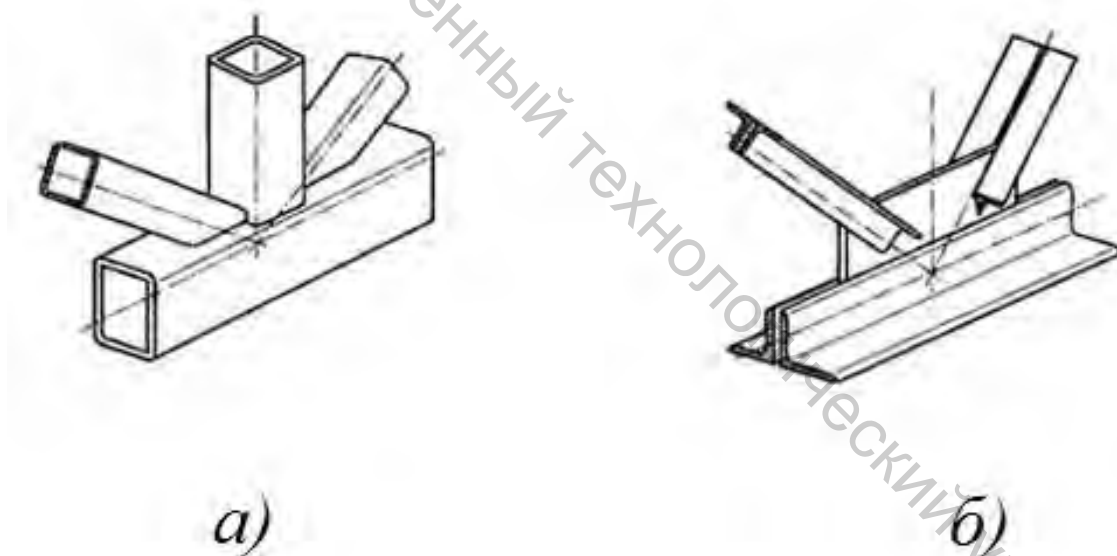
Изображение узлов ферм (а – с непосредственным примыканием элементов (элементы фермы их ГСП); б – на фасонках (элементы фермы и прокатных профилей))
